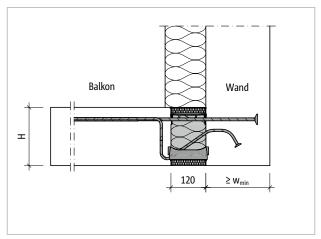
Schöck Isokorb® XT Typ K-U: Wandanschluss nach oben bei Außendämmung
